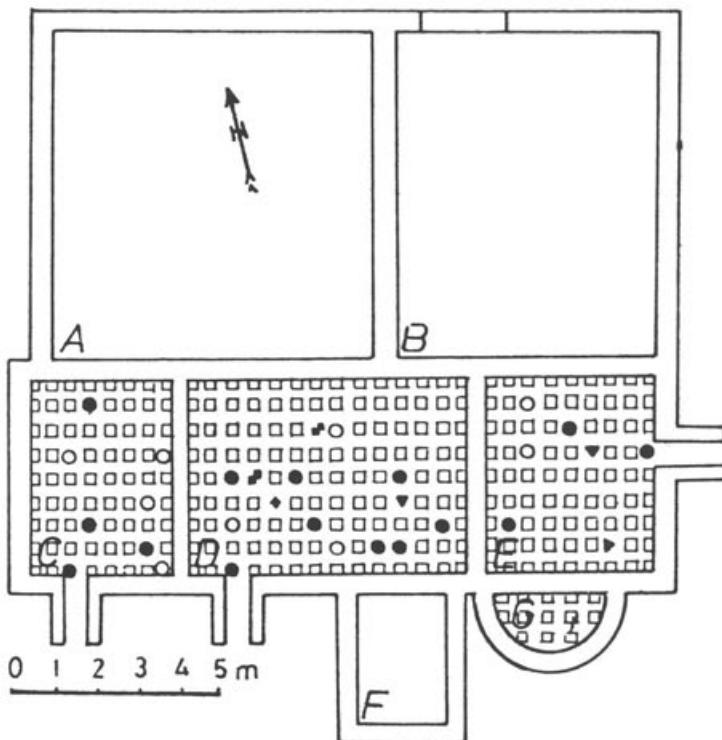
Bumbești, Plan des Bades (nach D. Tudor).
